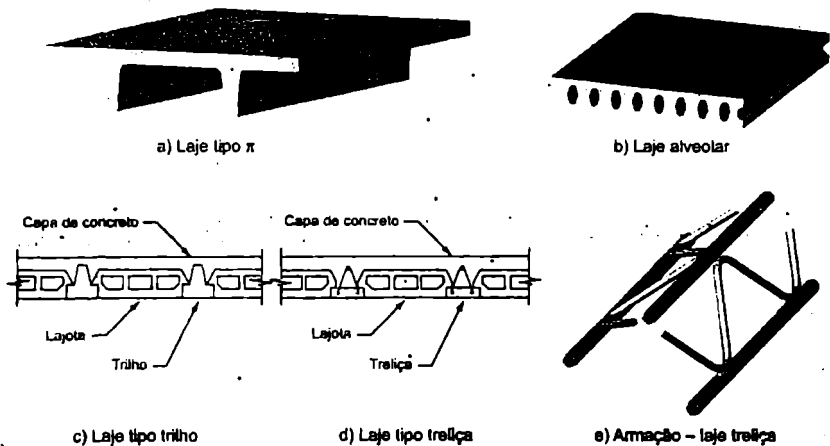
Seções transversais de lajes pré-moldadas: a) tipo  $\pi$ ; b) alveolar; c) tipo trilho; d) tipo treliça; e) armadura da nervura da laje tipo treliça.
